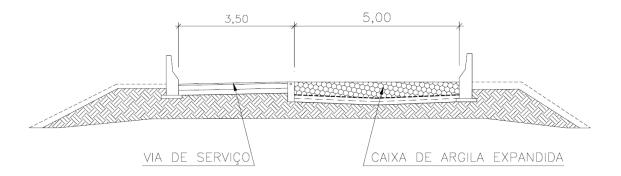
Seção Transversal da Área de escape Km 42+700 Pista Sul SP-150
